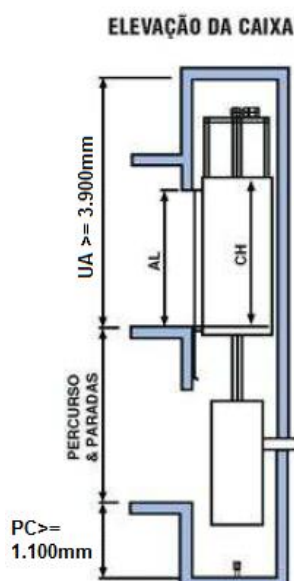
Croqui em elevação da caixa de corrida do elevador evidenciando última altura e profundidade do poço
